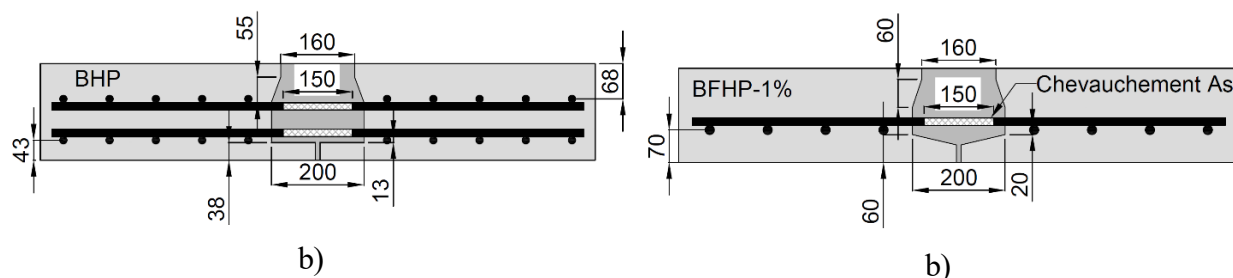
Forme du joint de connexion, a) Tel que construit, b) Adaptée pour les dalles en BRF
